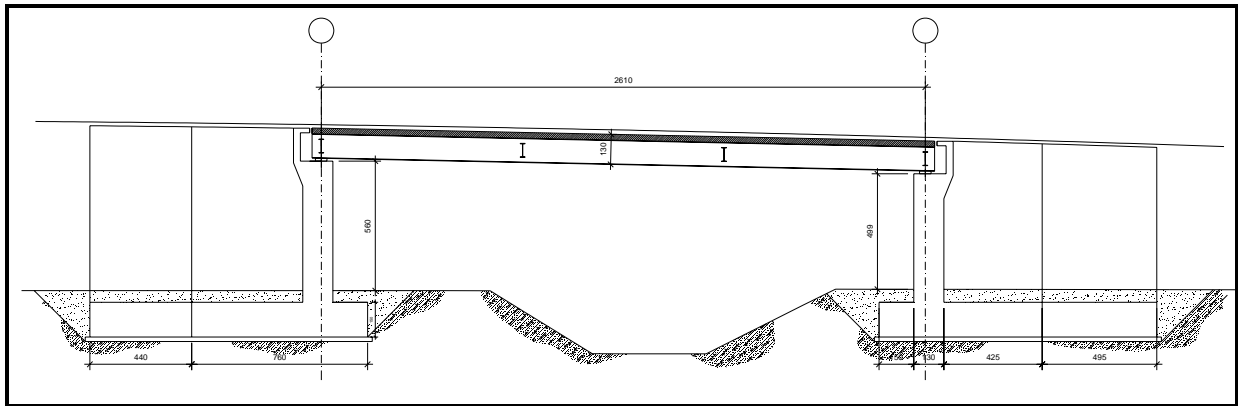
Tipologico del Ponte sul canale – Sezione Longitudinale
